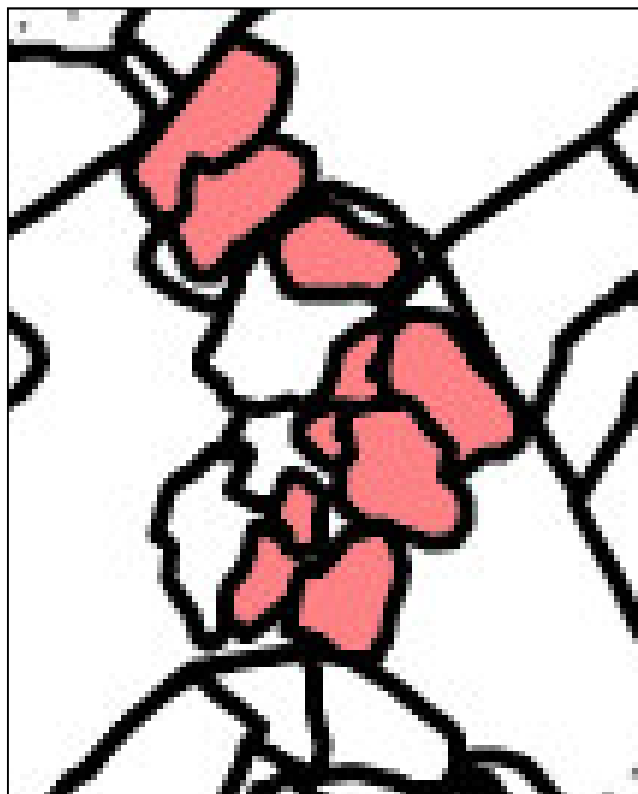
Planta de les intervencions, en vermell el mur intervingut.
